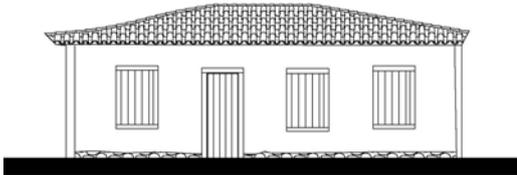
Fachada Anterior (Acervo PROAU/FAU/UnB).
